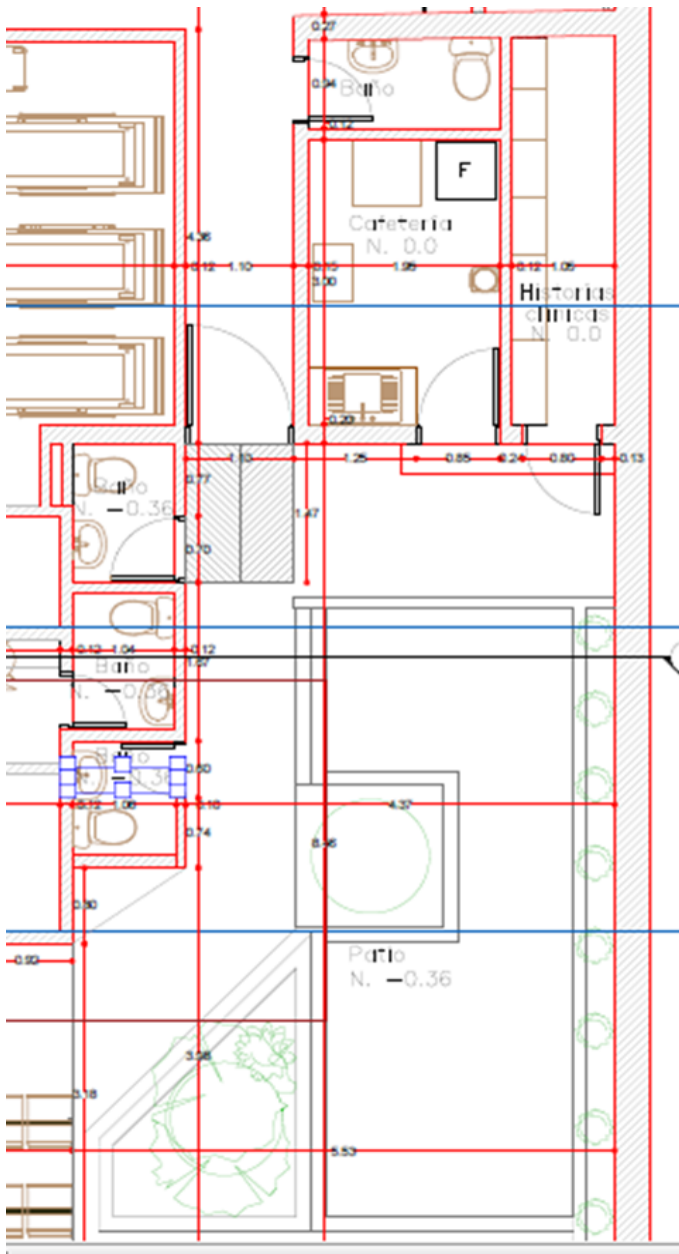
Planos del estado actual de la Clínica Revivir.
